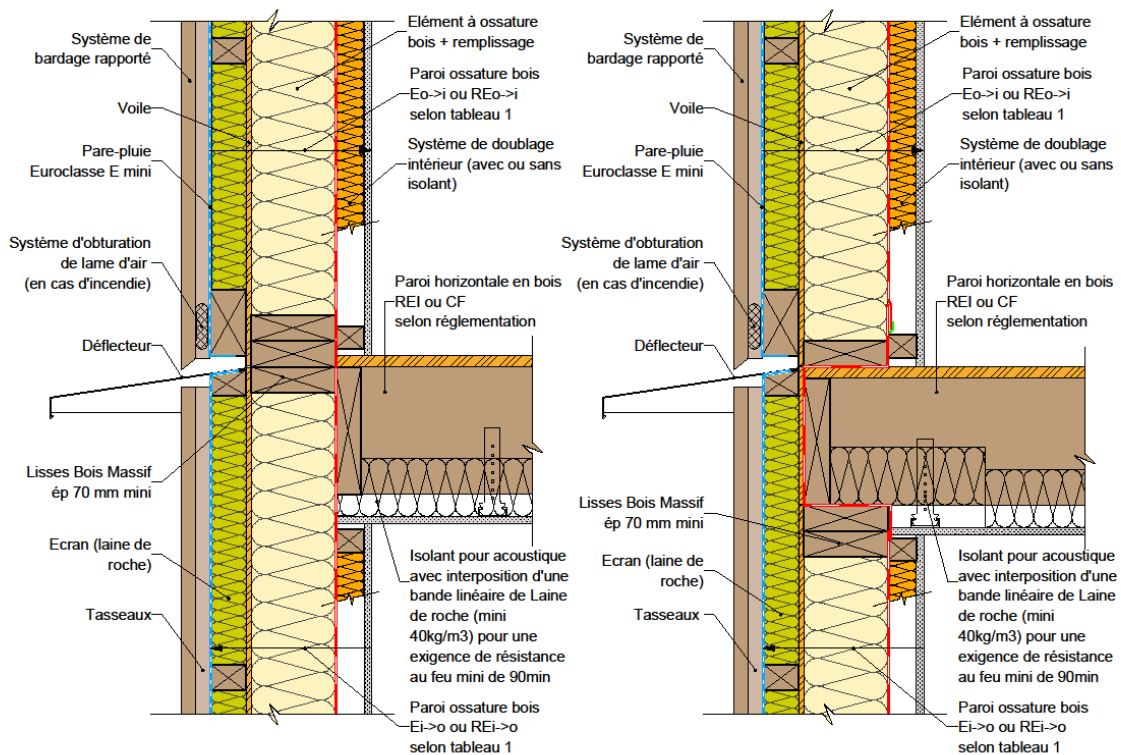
Façade/mur ossature bois & plancher en ossature bois.
